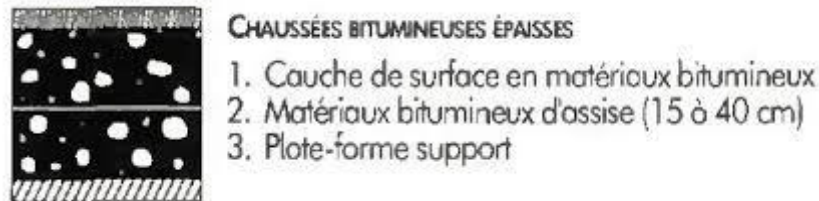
Structure d'une chaussée bitumineuse épaisse.
